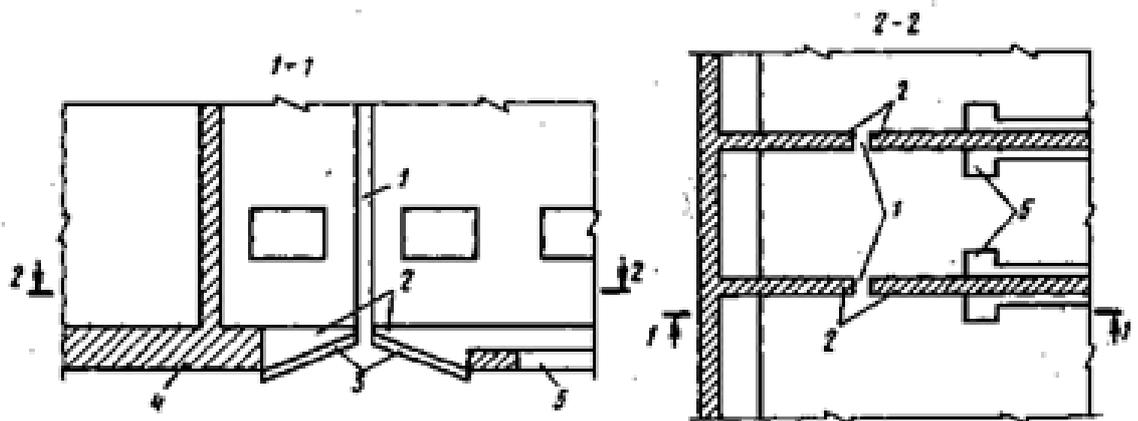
Устройство консолей на участке с деформационным швом: 1 — осадочный шов; 2 — консоли; 3 — воздушные зазоры; 4 — фундамент тяжелой части здания; 5 — фундамент под стену примыкающей части здания
